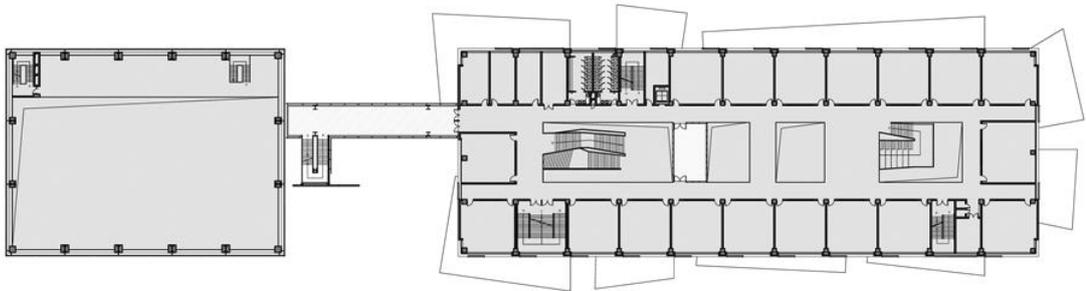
PLANTA TERCEIRO E QUARTO PAVIMENTO
